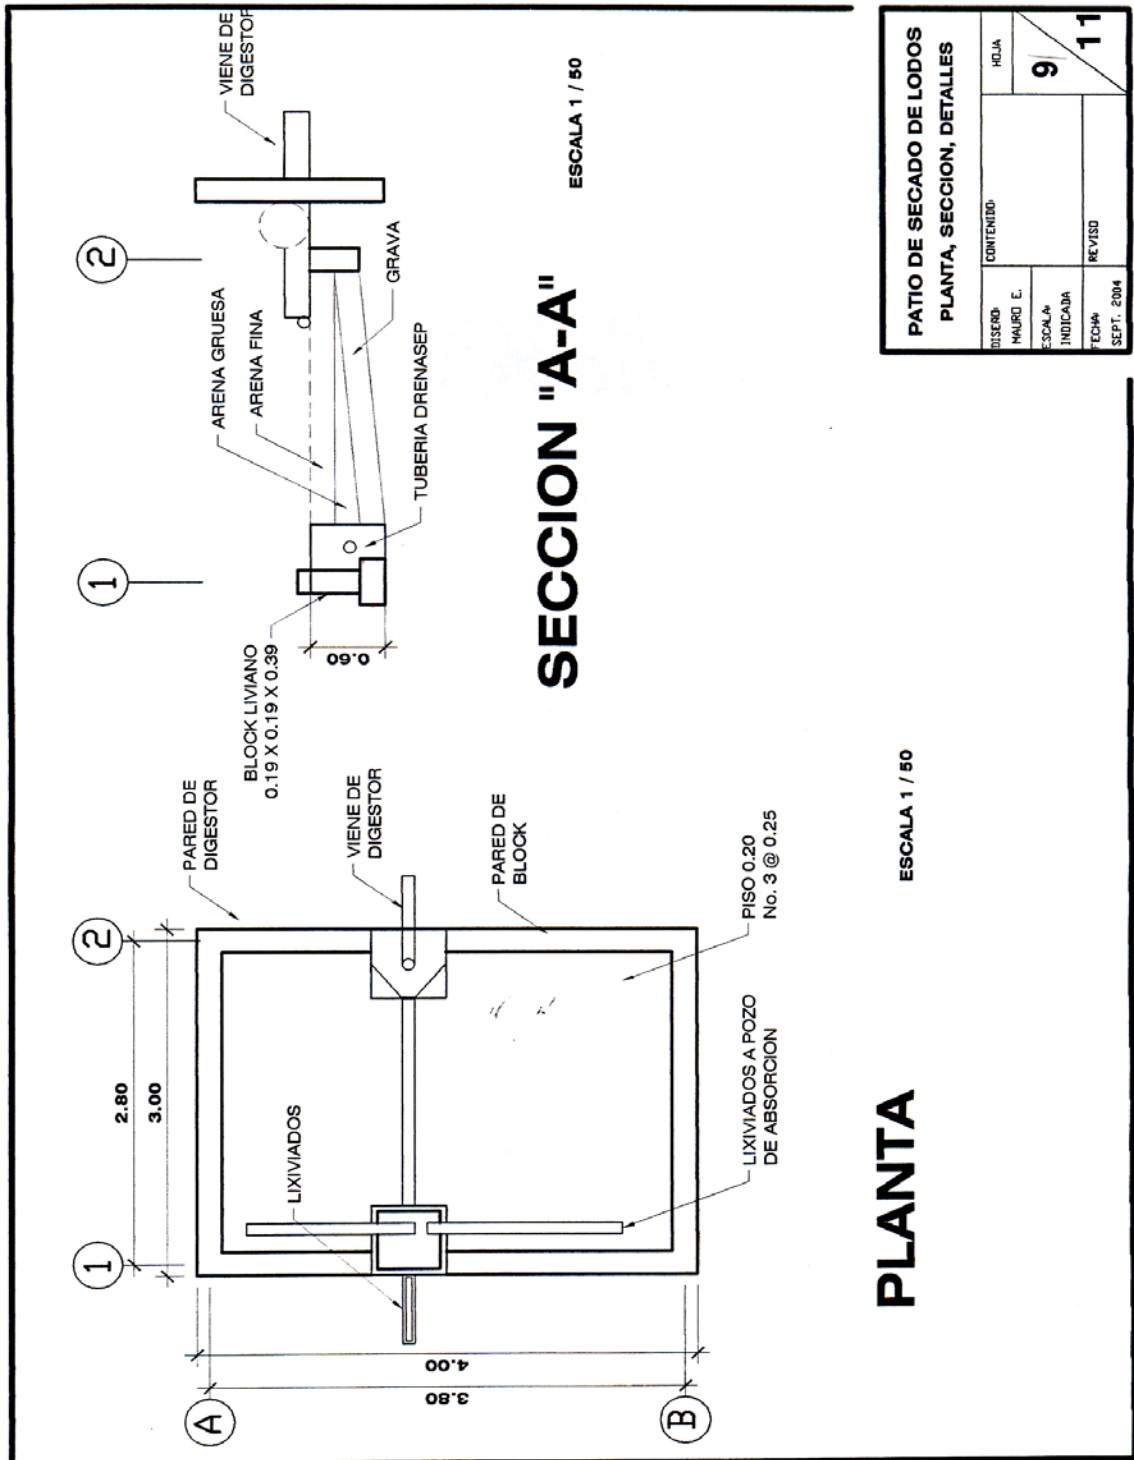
Plano del patio de secado de los lodos de la planta de tratamiento de aireación extendida.
